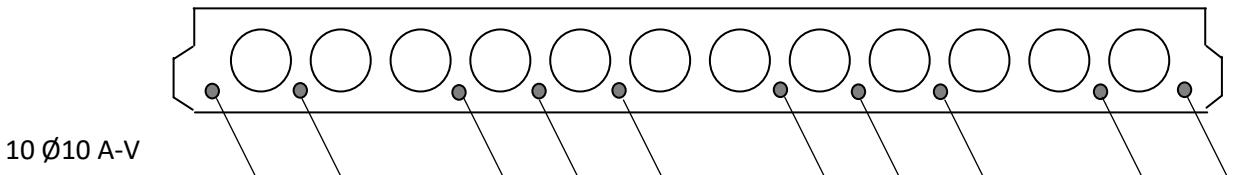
Размещение продольной напрягаемой арматуры в поперечном сечении плиты
